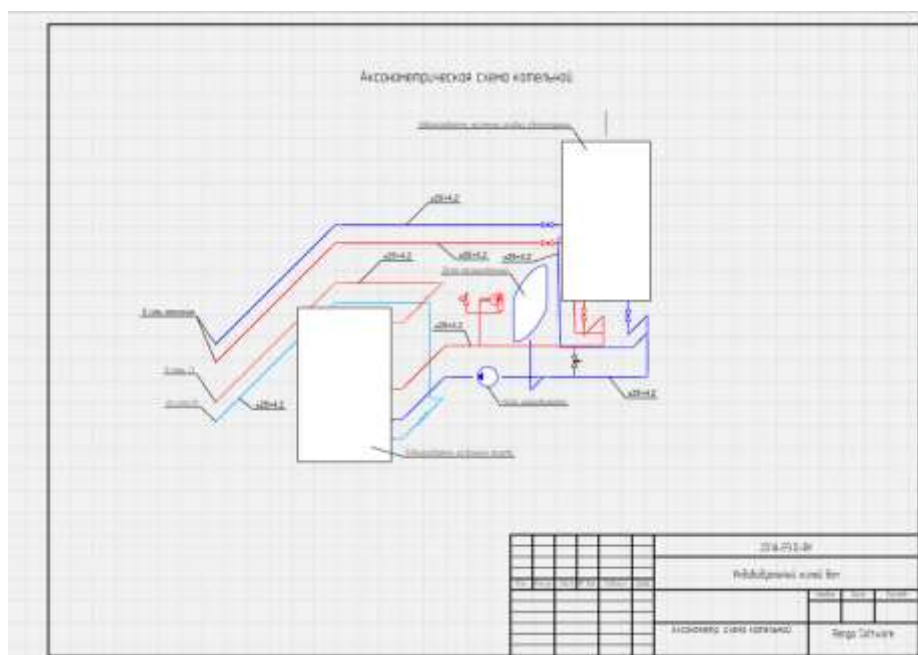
Аксонометрическая схема котельной индивидуального жилого дома
